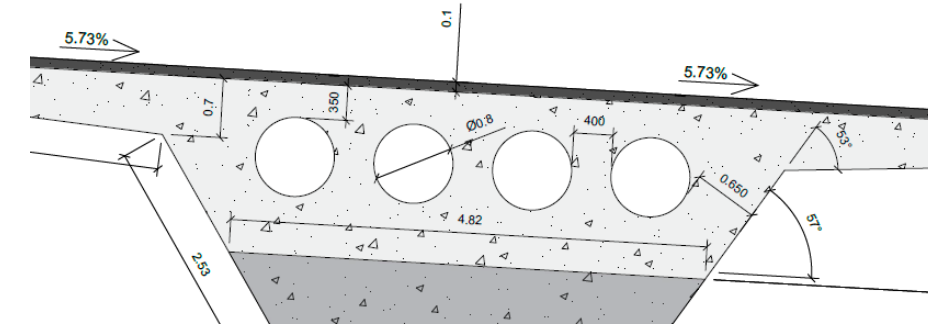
Detalle de los aligeramientos de polietileno expandido en una sección.
